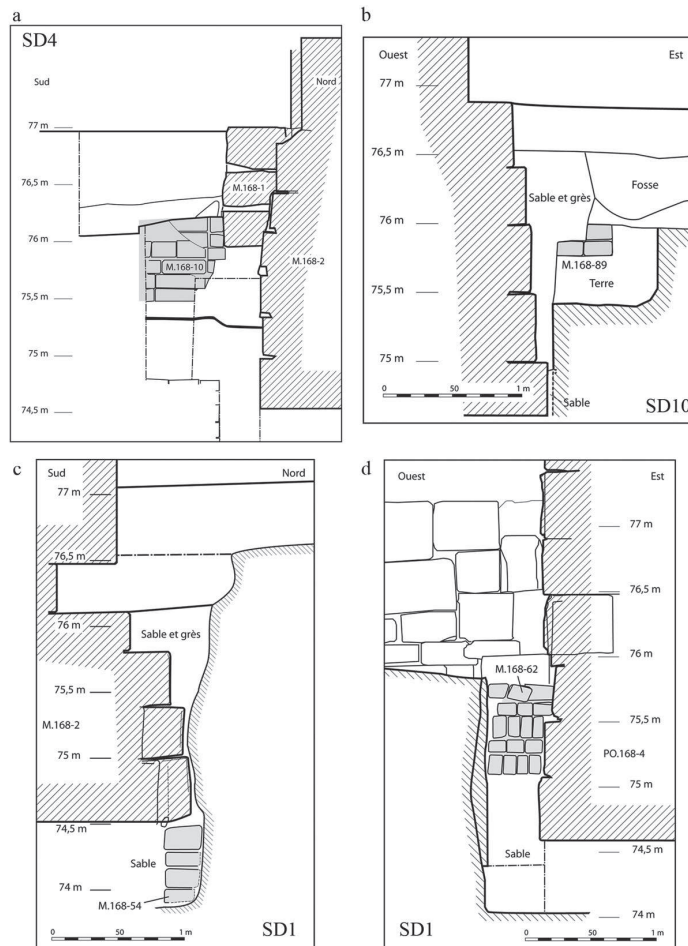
Coupes schématiques des structures en brique rencontrées dans la fondation du temple d’Opet – G. Charloux.
